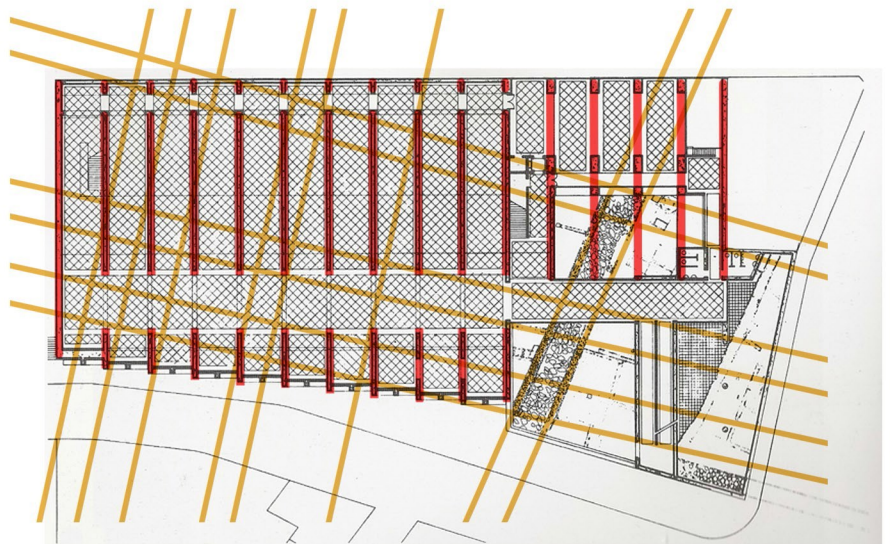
Planta del edificio modificada por el alumno, en naranja trazado de las ruinas y en rojo el sistema amurallado del museo
